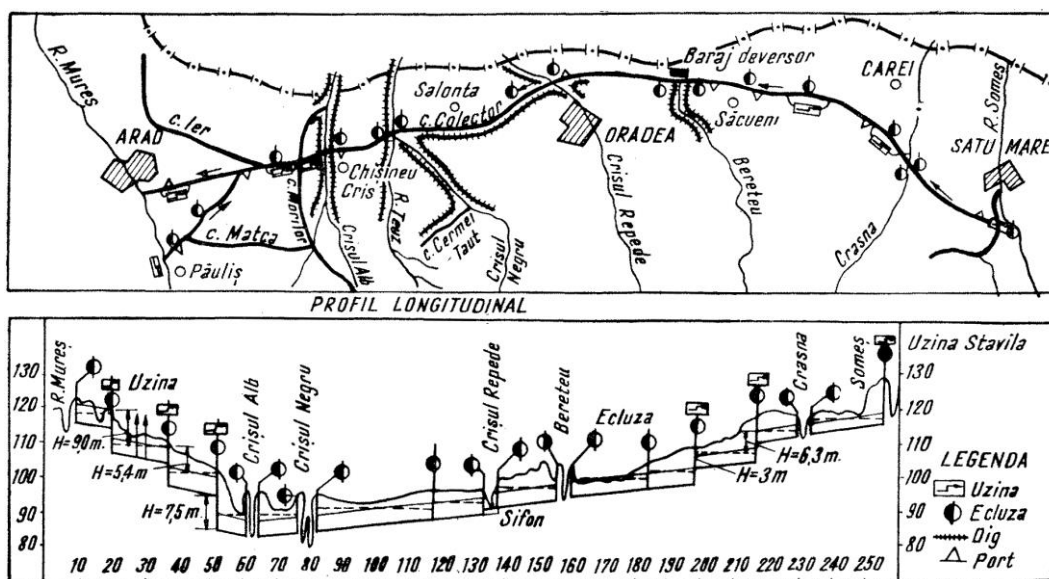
Schița de plan a canalului Someș – Crișuri – Mures.
